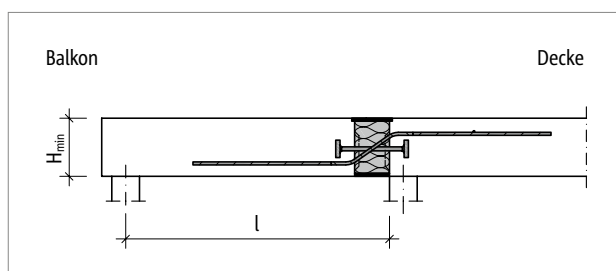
Schöck Isokorb® XT Typ QP: Statisches System
